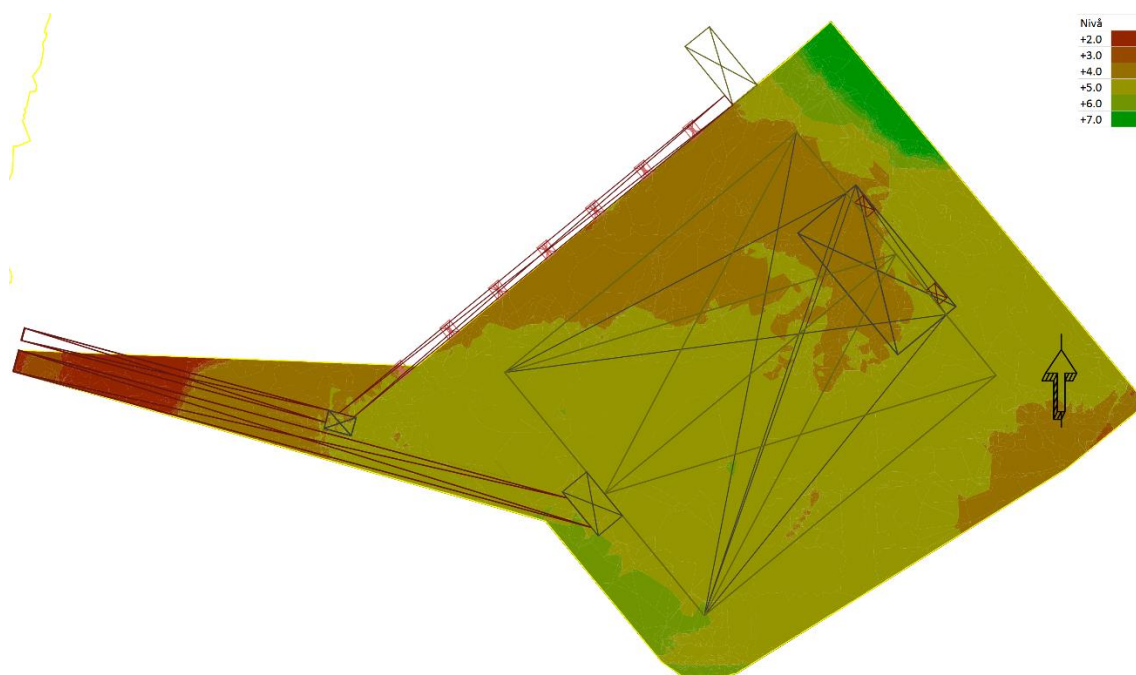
Befintliga konstruktioner där silorna 1–6 planeras att anläggas.
